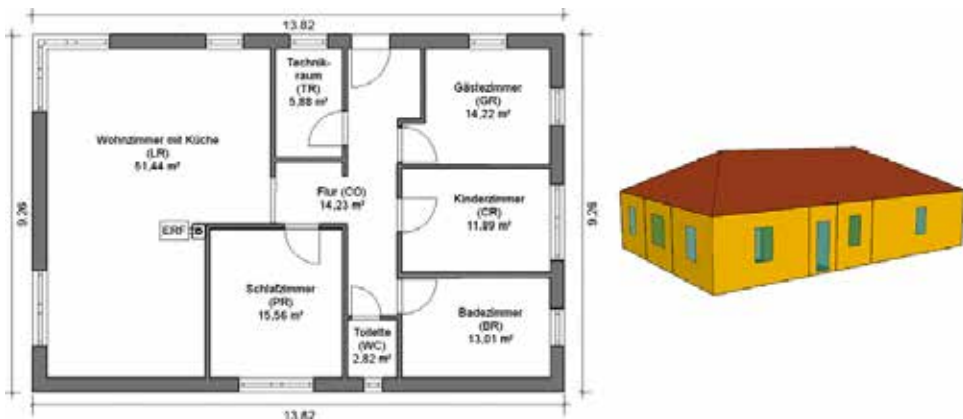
Grundriss und 3D-Ansicht des simulierten EFH in Bungalow-Bauweise
